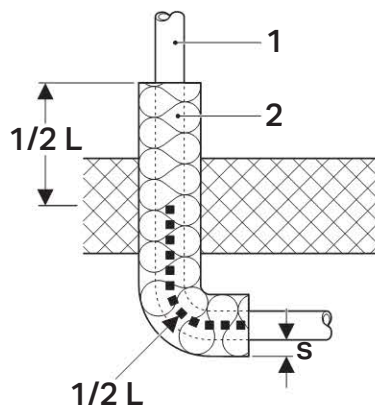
Brandschutz Geberit Mepla / PushFit: Deckendurchführung Massivdecke, Bogen
